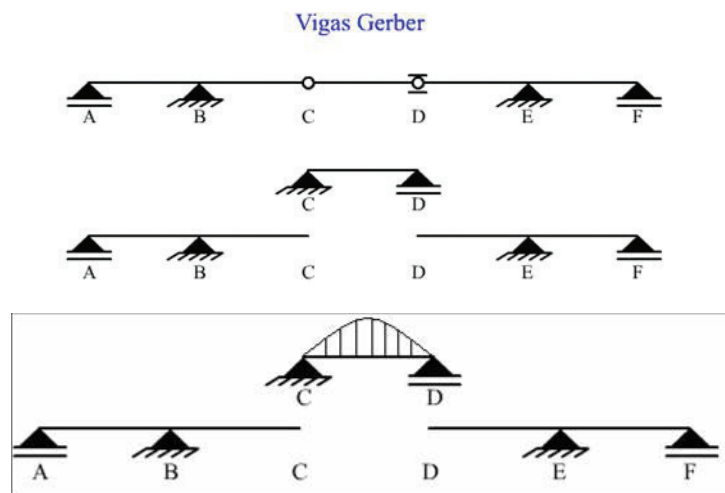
Esquema de funcionamiento estructural inspirado en el puente de Minato Oh-Hashi de Japón
